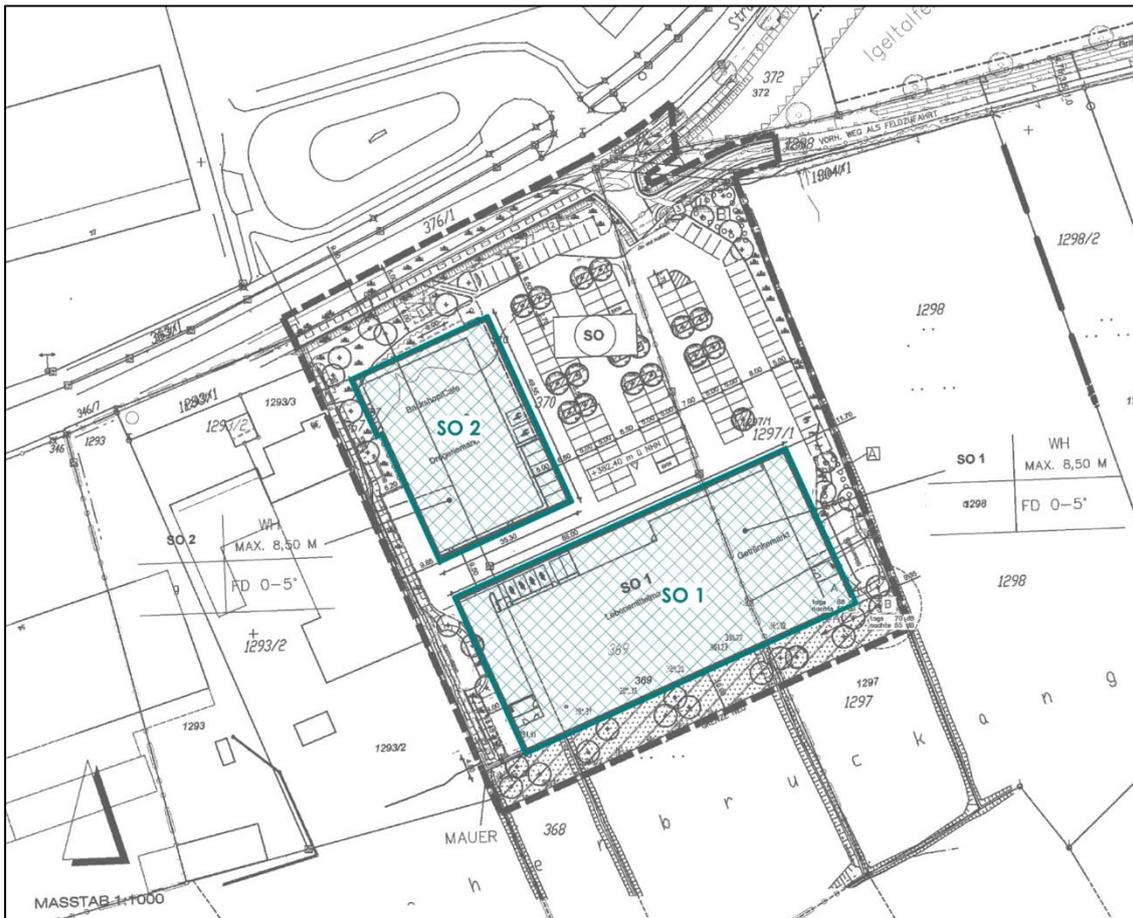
Lageplan mit Darstellung der Emissionsbezugsflächen
